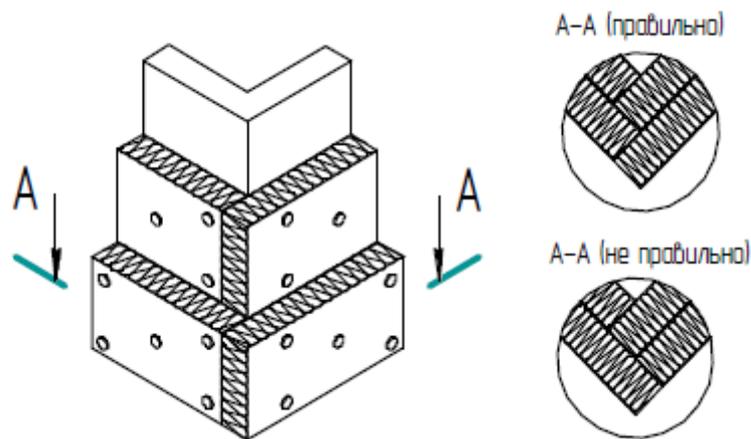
Схеми укладання плит утеплювача на кут будівлі. Двошарове утеплення
